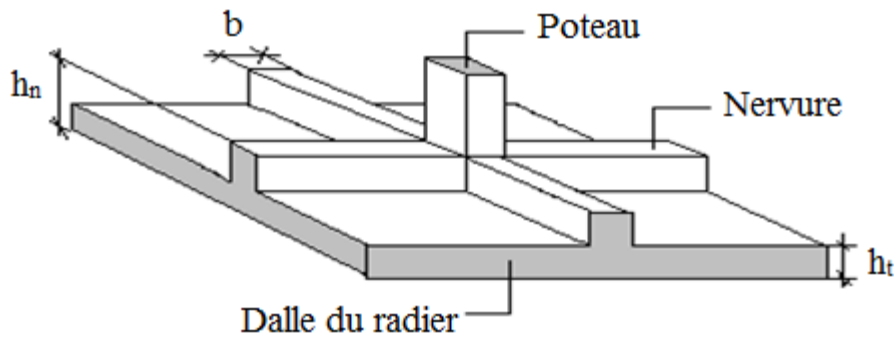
Disposition des nervures par rapport au radier et aux poteaux.
